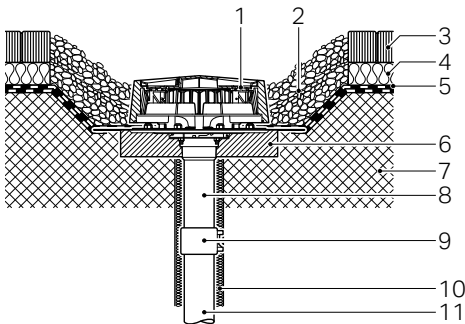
Aufbau Massivdach nicht gedämmt, mit Bitumen-Dachabdichtung, begehrbar
